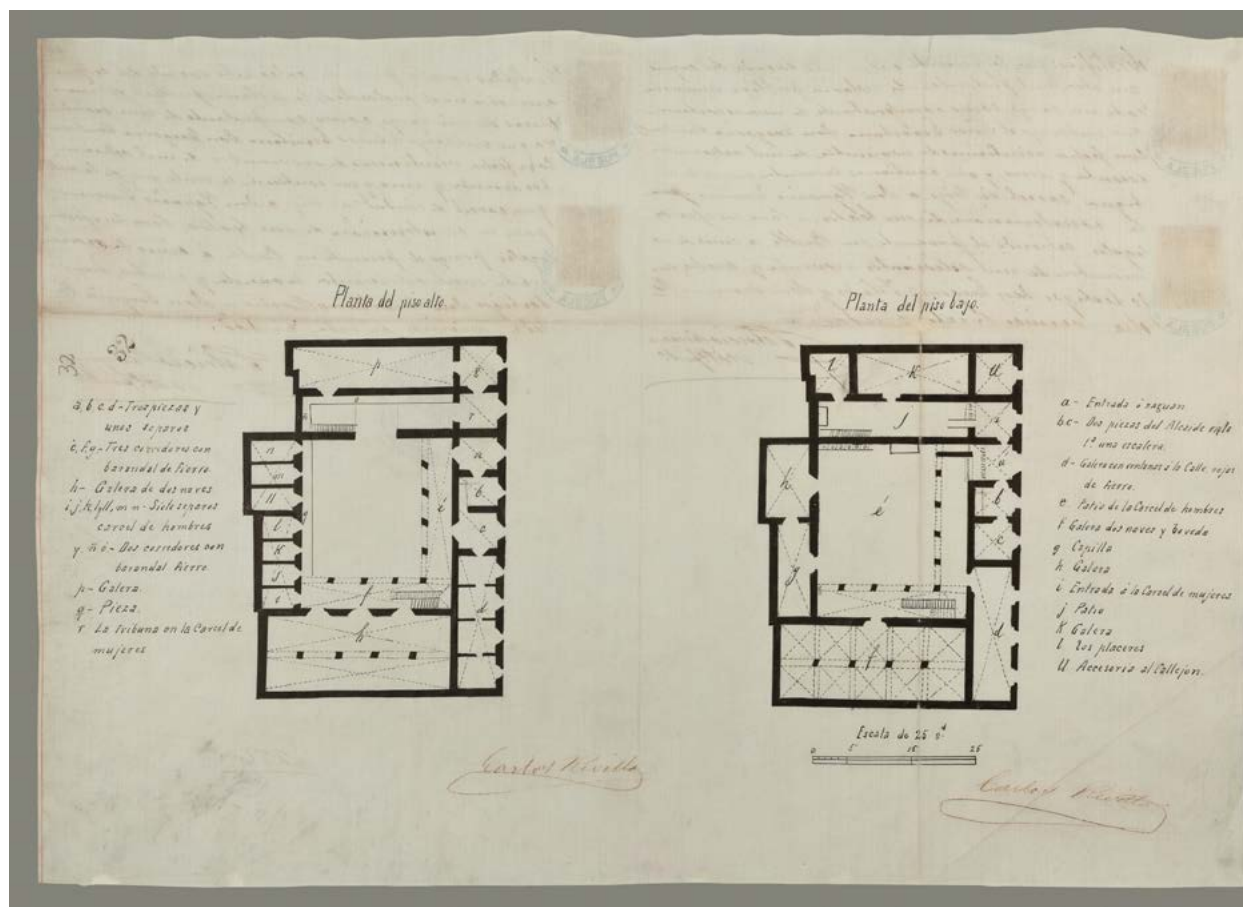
Croquis de la cárcel municipal, planta alta y baja.
